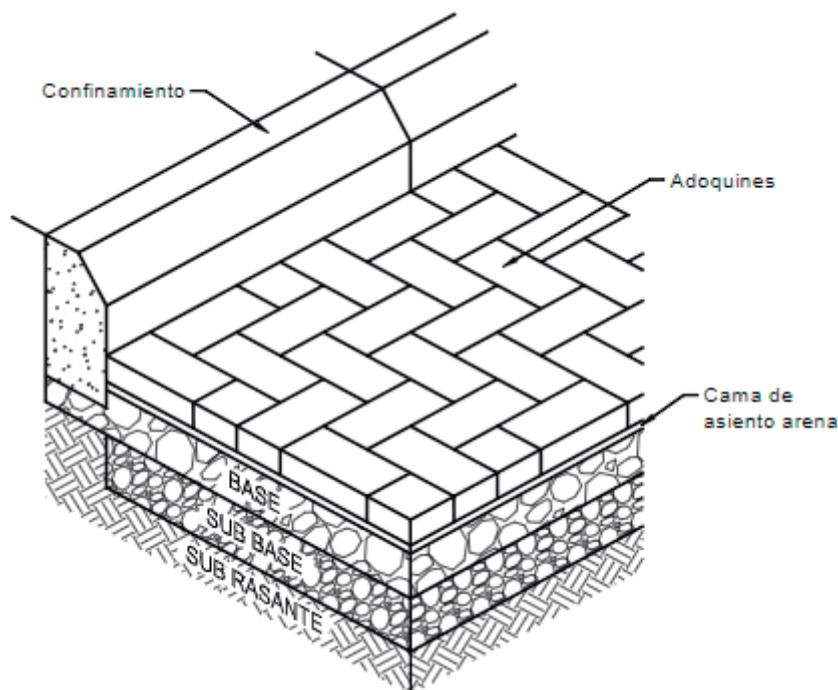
1. Estructura de un pavimento de adoquines en concreto
